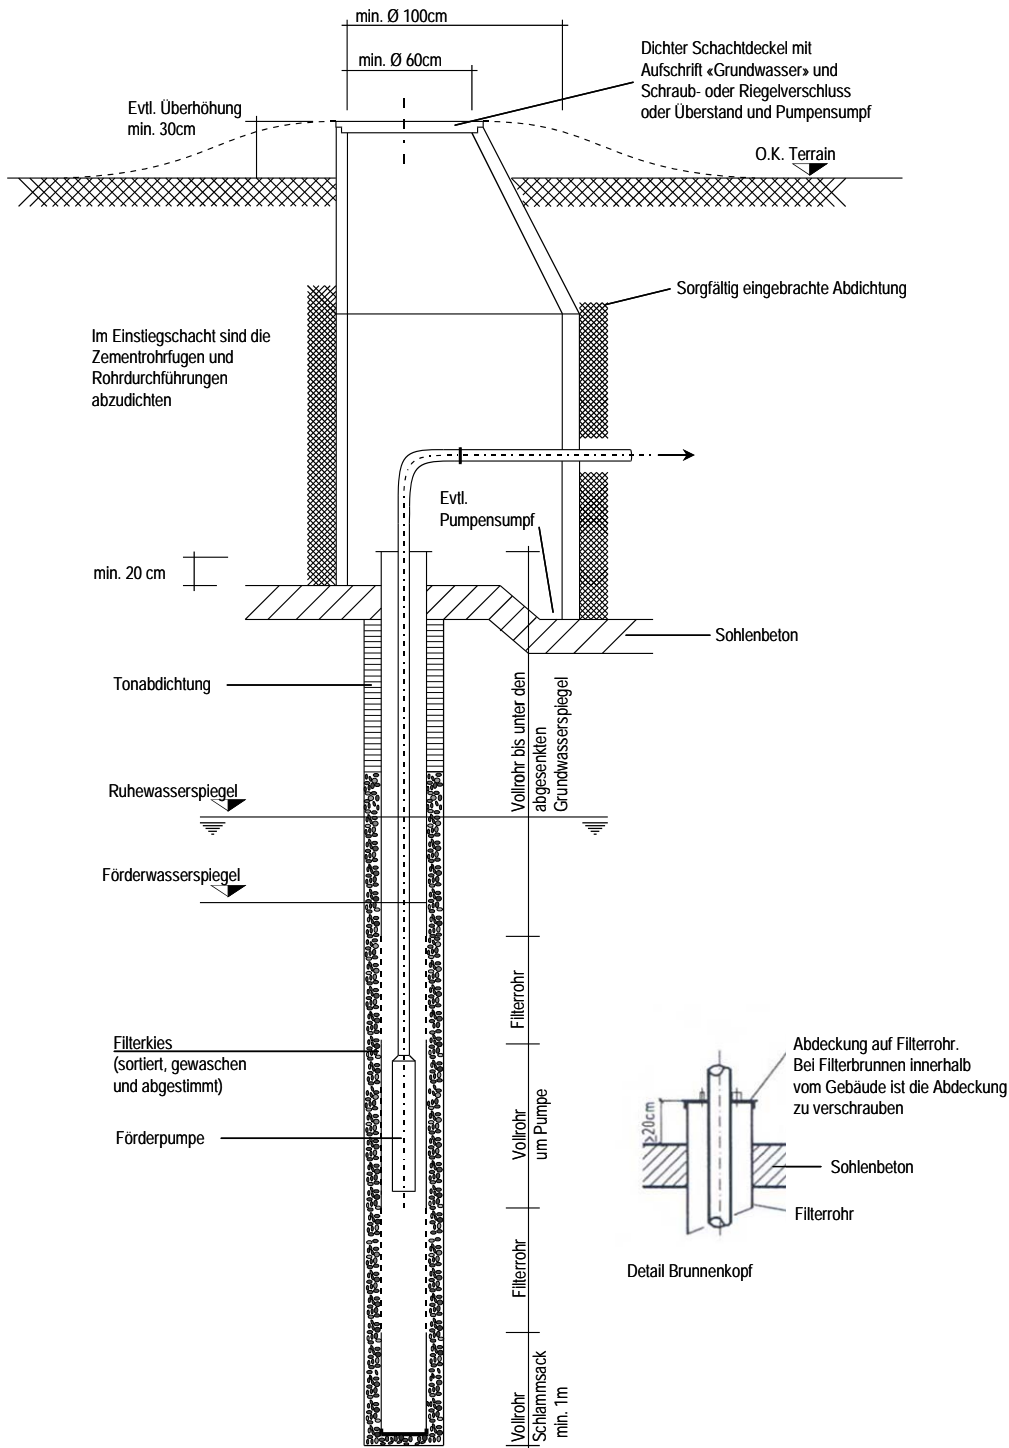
> Prinzipielle Darstellung einer Grundwasser-Wärmepumpenanlage
